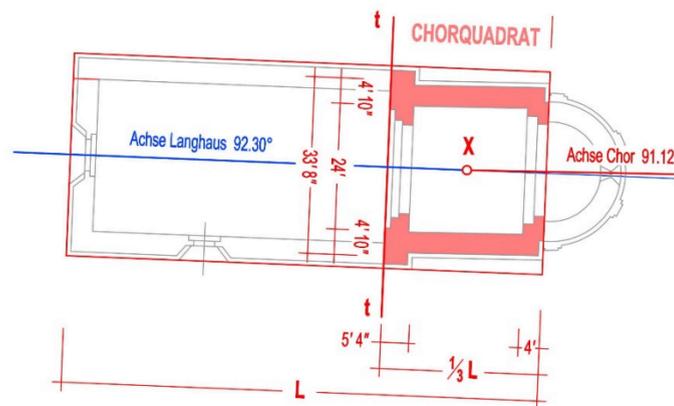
Pfarrkirche Schönggrabern, Rekonstruktion Grundriss Chor
